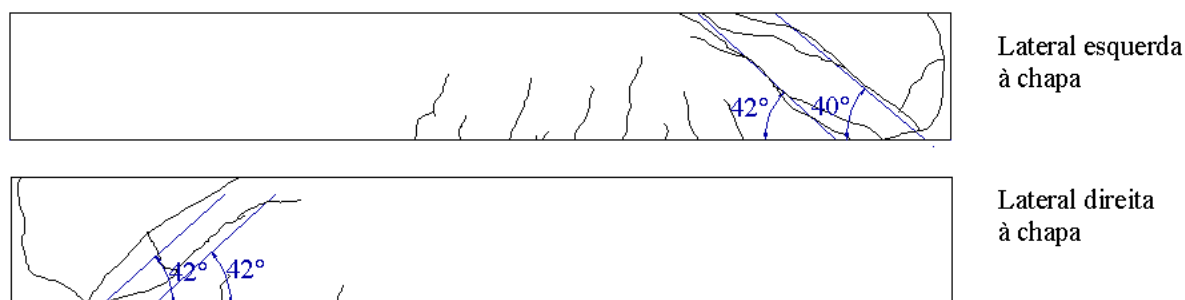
Fissuração na viga V5 e inclinações das fendas
